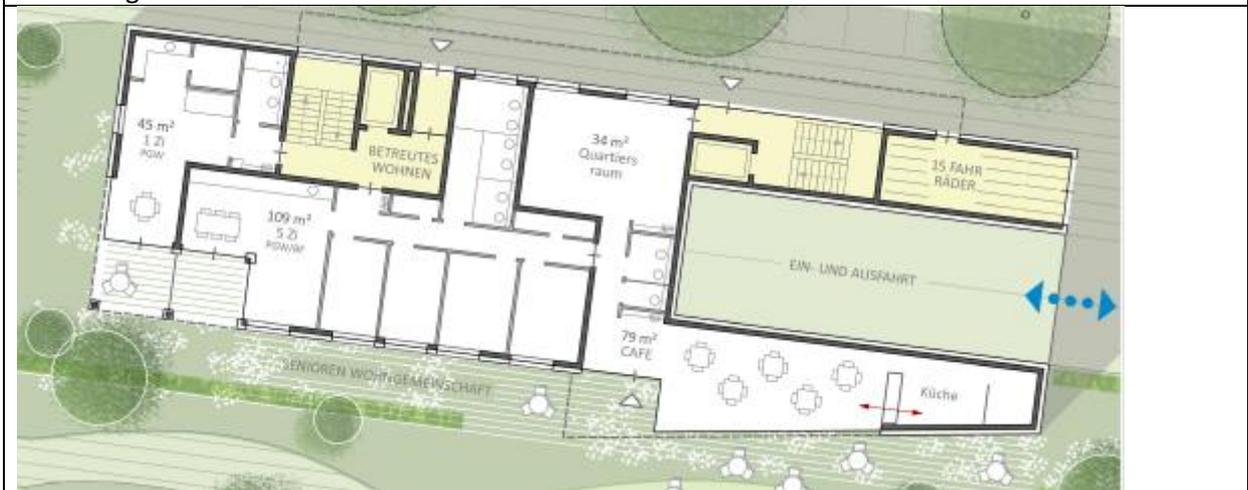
Grundriss EG östlicher Zeilenbau mit Tiefgaragenzufahrt und Café
